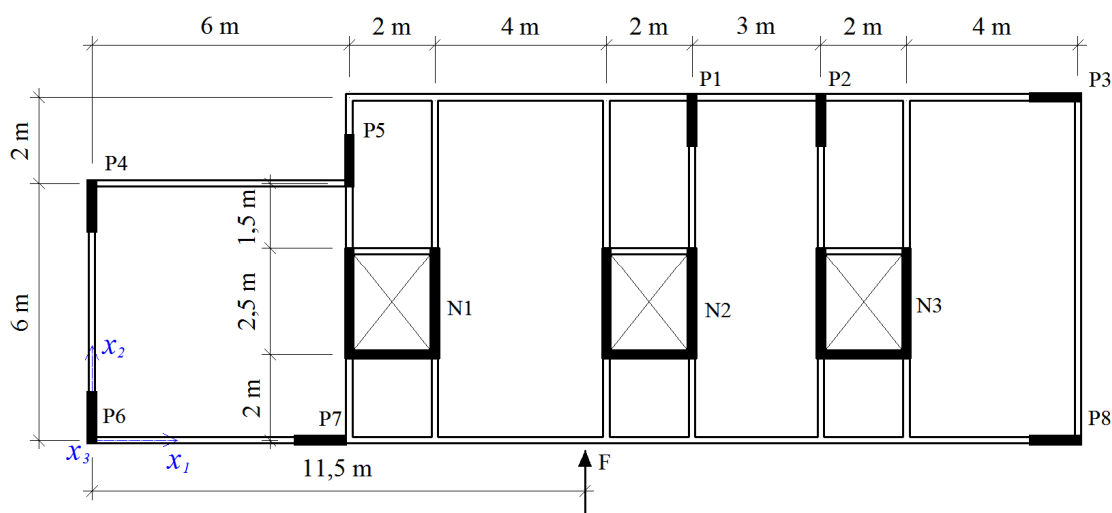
Exemplo 7: Planta do pavimento tipo
